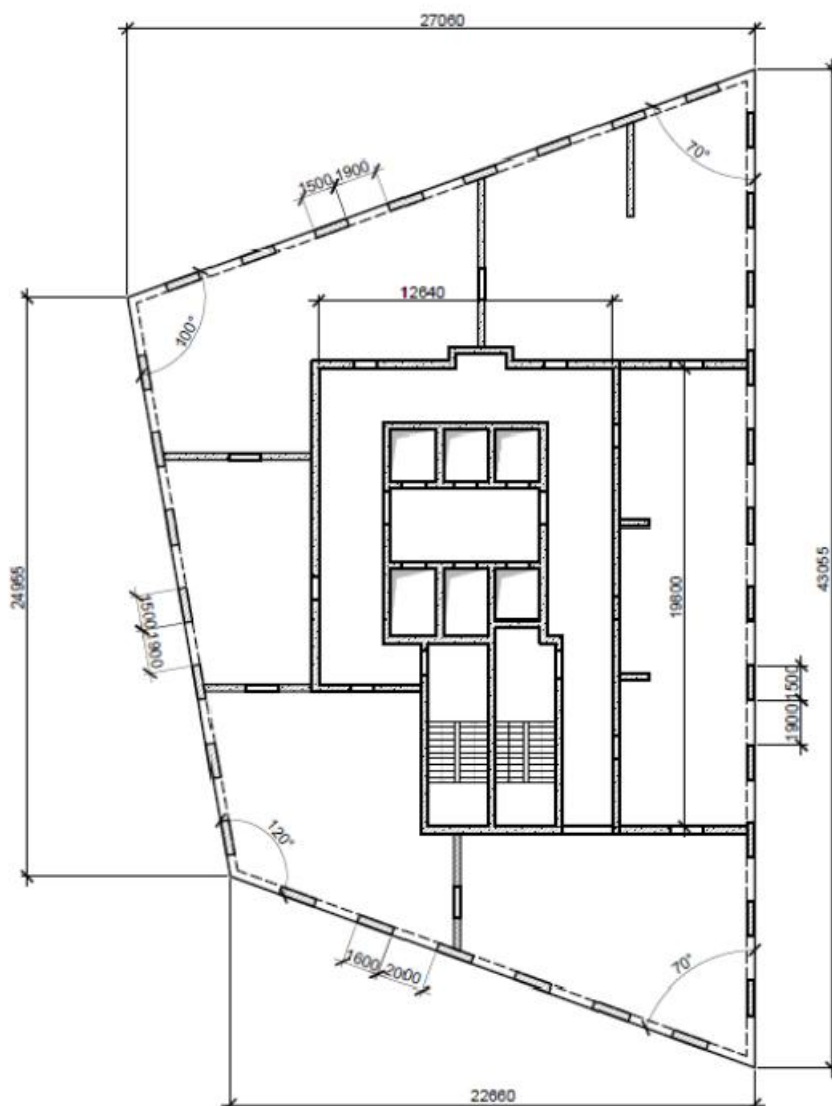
Задание на курсовой проект - план типового этажа высотного здания из монолитного железобетона.
